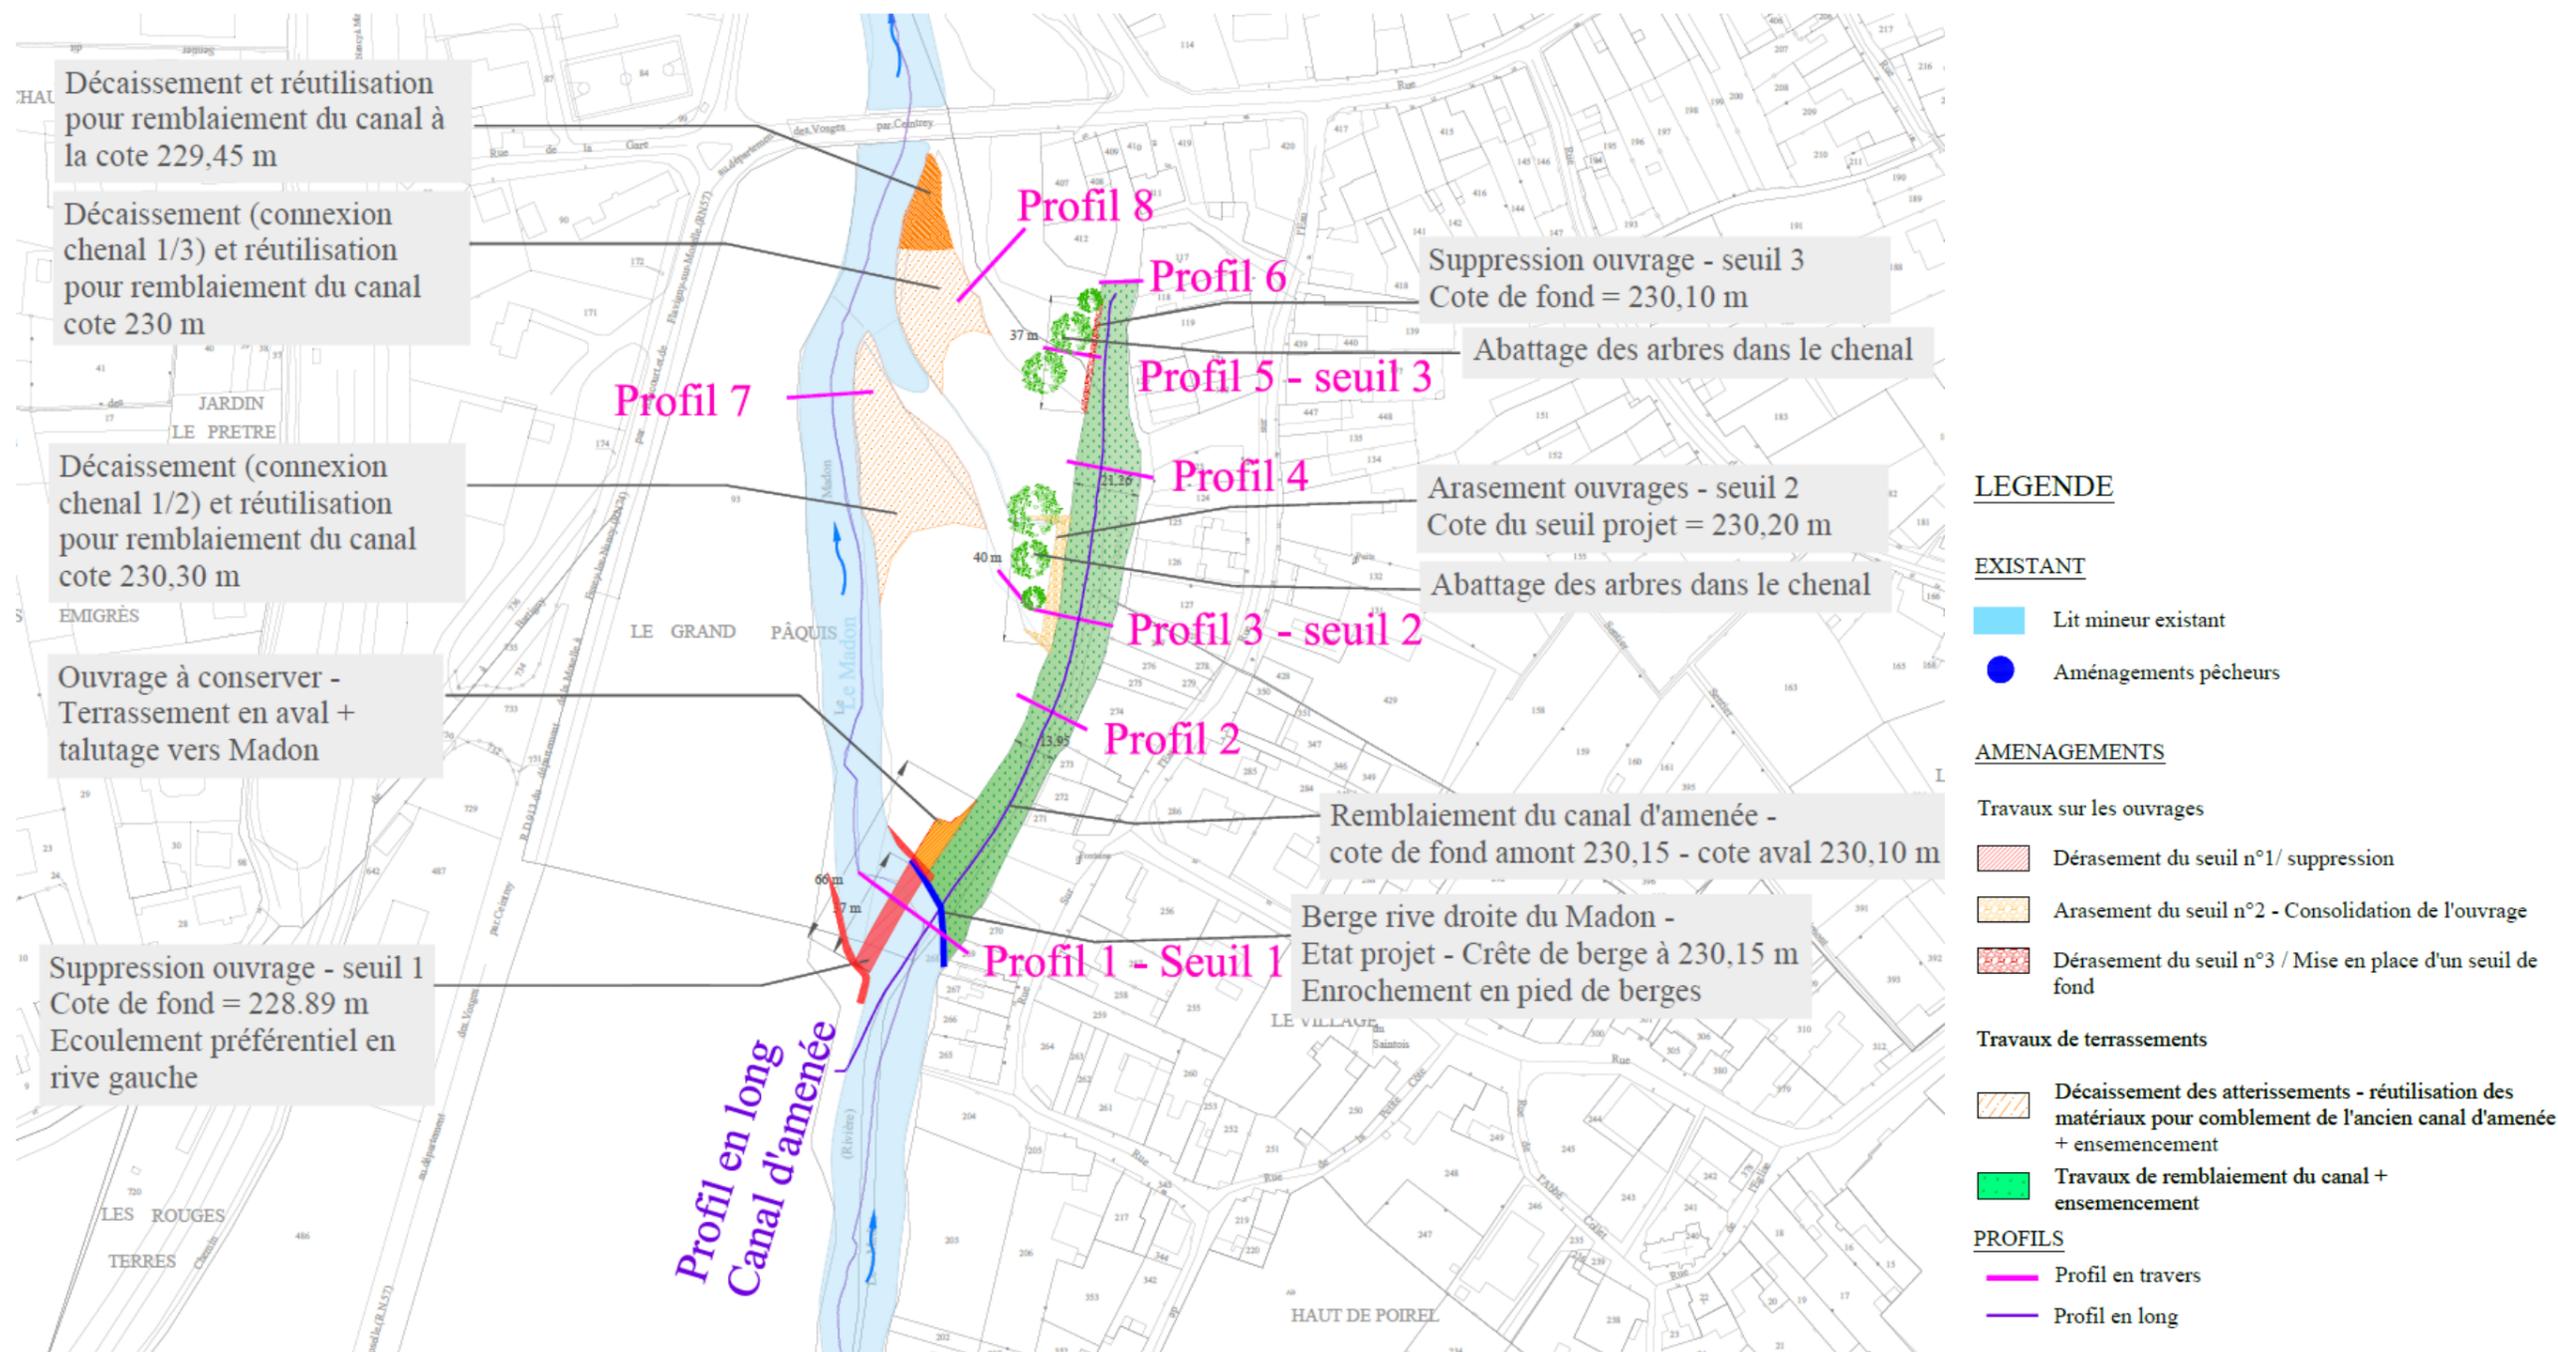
Extrait de vue en plan des aménagements de l'opération 6 à Ceintrey et Voinémont- plan AVP (ARTELIA, mai 2021)
